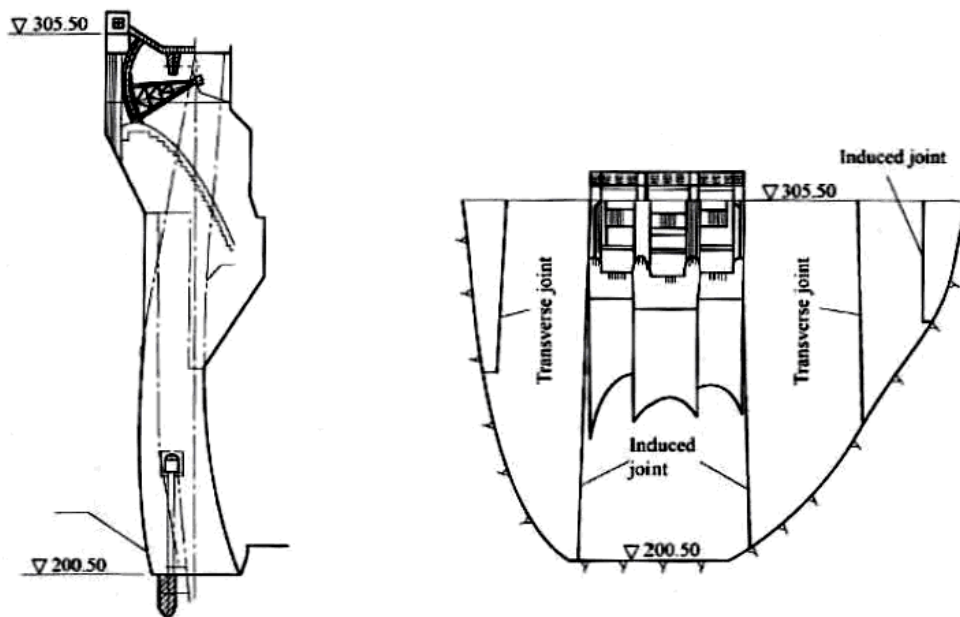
Secção transversal e alçado da barragem de Zhaolaihe (Shengpei, 2007)
